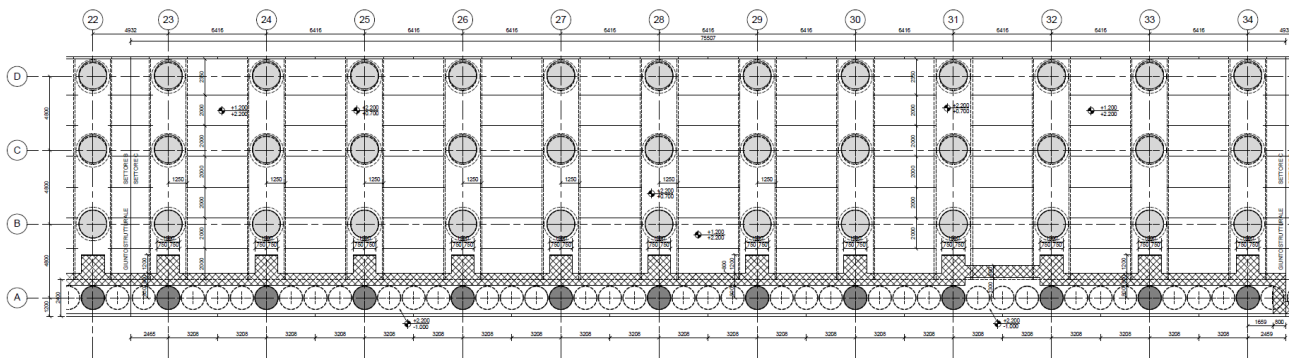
PE: Settore C – pianta fondazioni – stralcio.
